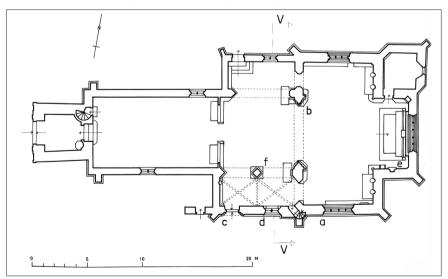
Pontivy, chapelle Notre-Dame de La Houssaye, plan au sol
